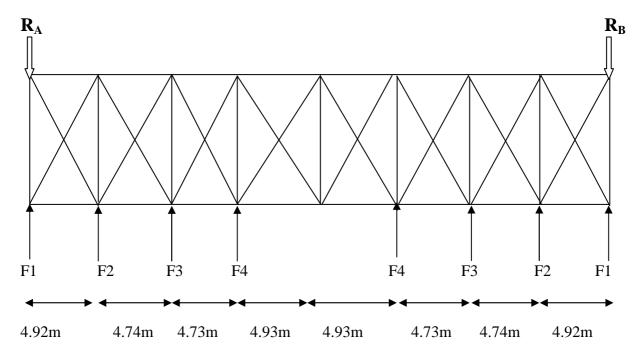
Schéma statique de la poutre au vent en pignon.
